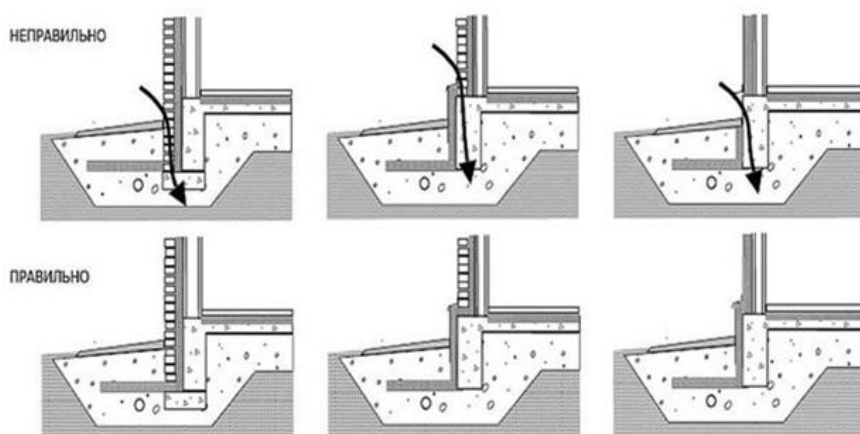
Ошибки утепления фундаментов и мостики холода
